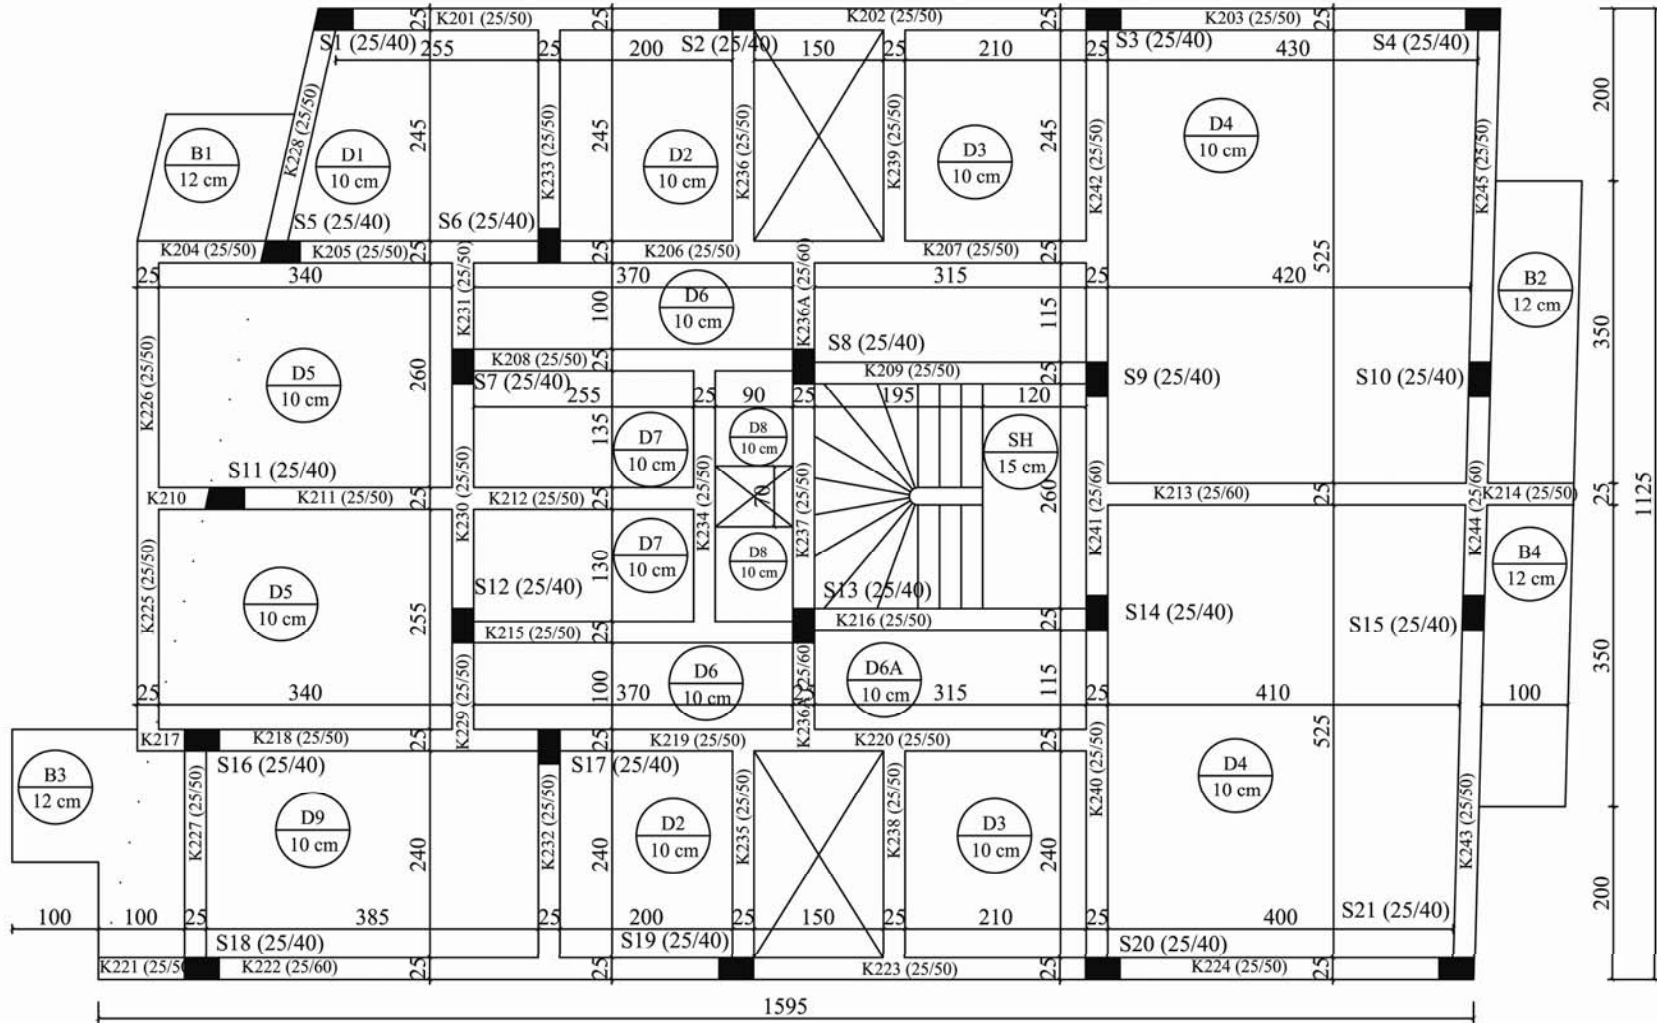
B3\_5'in kat kalıp planı
